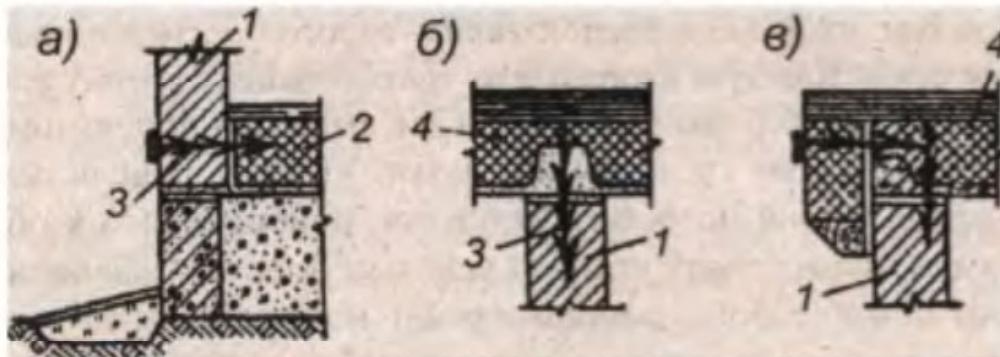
Крепление наружных и внутренних стеновых панелей из арболита с плитами покрытий и перекрытий из арболита:
